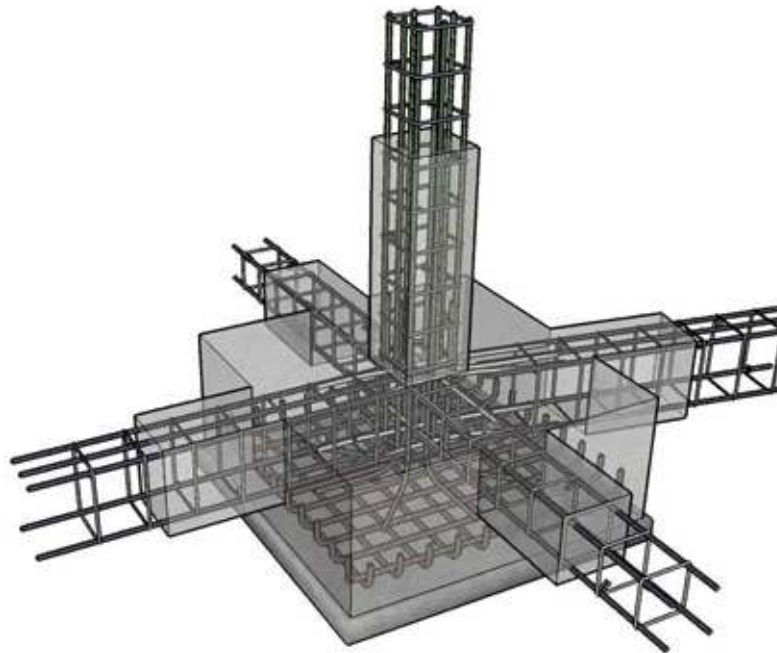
, ejemplo de una zapata asilada con armado de acero.
